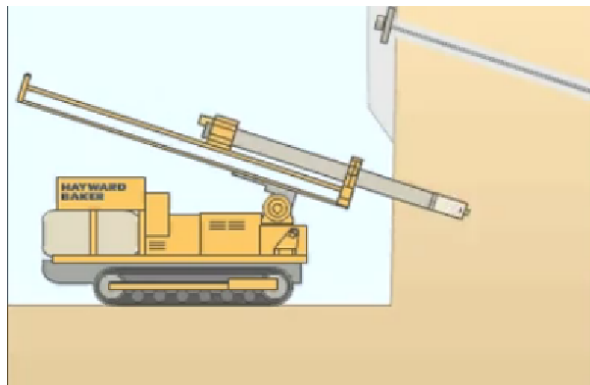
Execució Soil Nailing. Perforació (Font: www.youtube.com)
